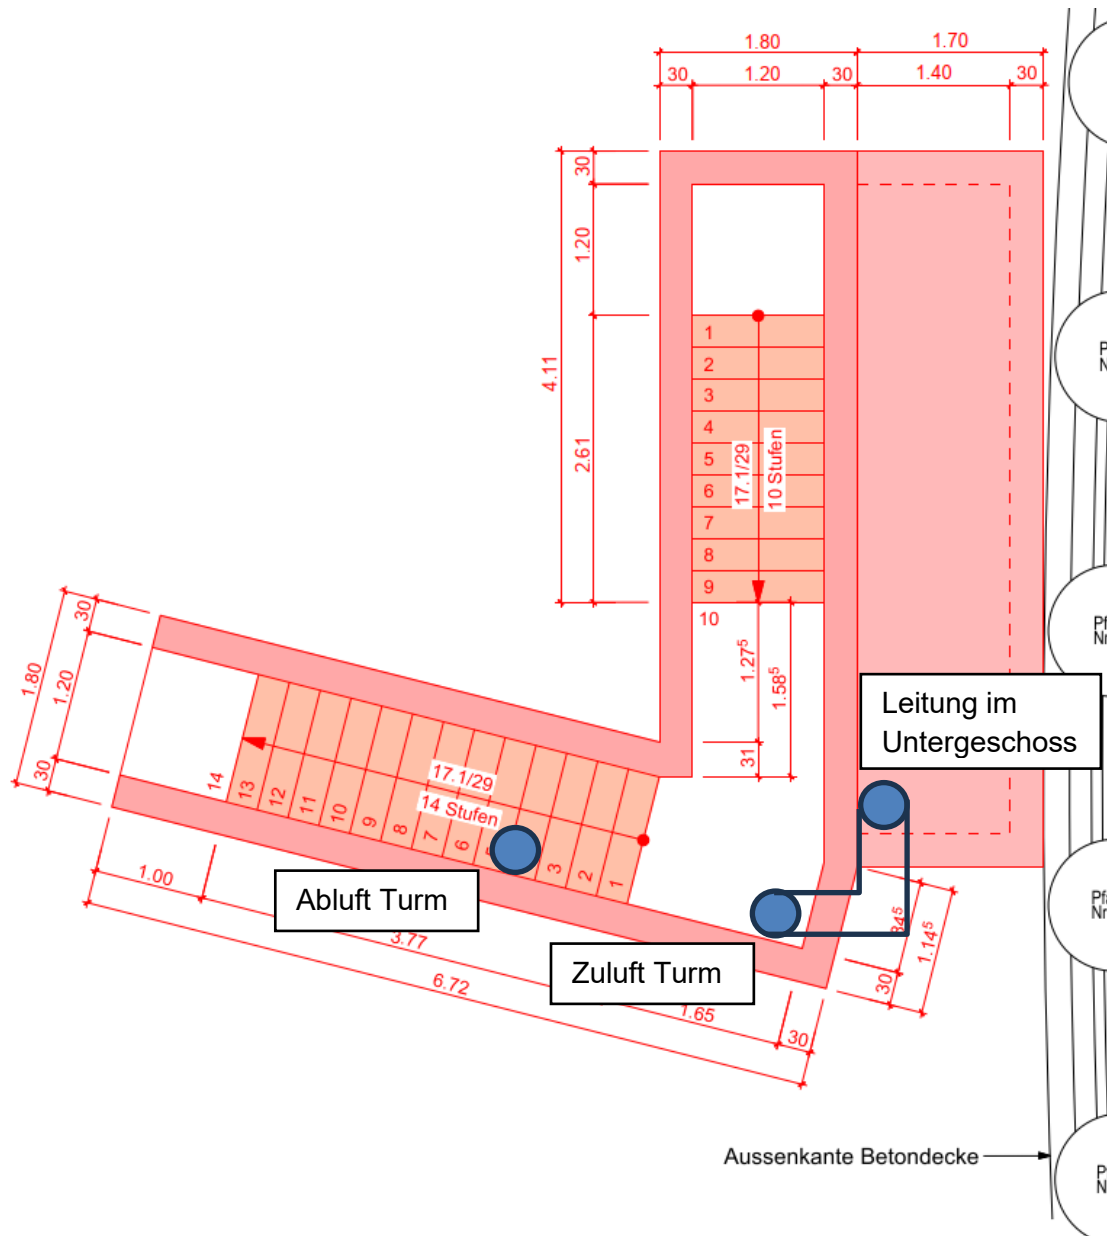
Konzept für Lüftungsanlage im Fluchttreppenhaus - Grundriss
